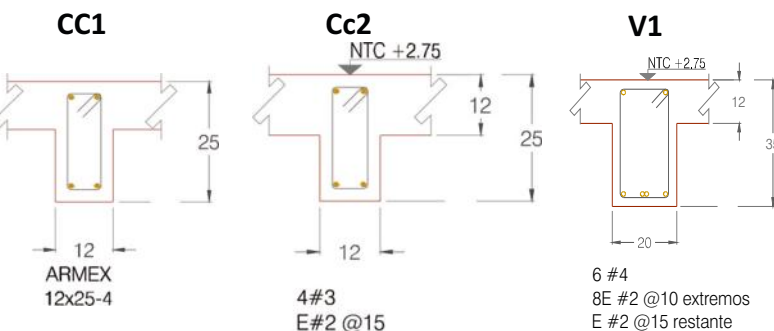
DETALLES Y SECCIÓN DE CADENAS DE CERRAMIENTO CC1, CC2 Y V1
